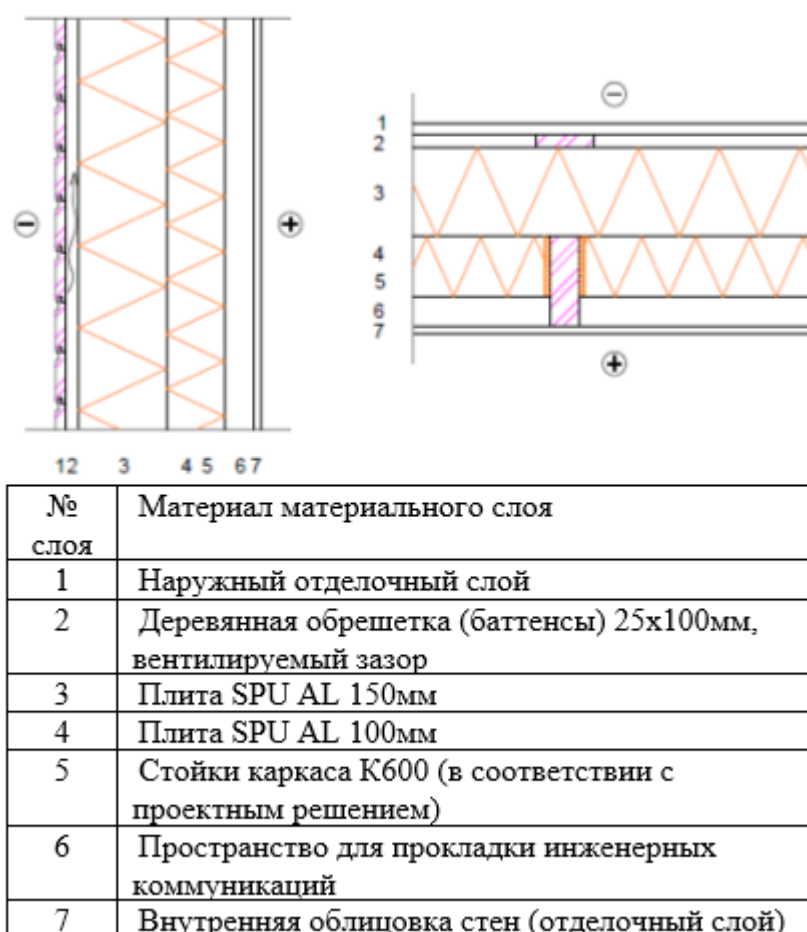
Конструктивное решение наружной стены здания с деревянным каркасом
